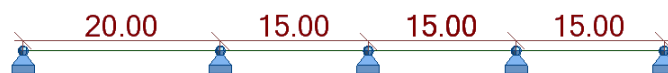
Distâncias entre apoios da viga de bordadura do piso 1.
